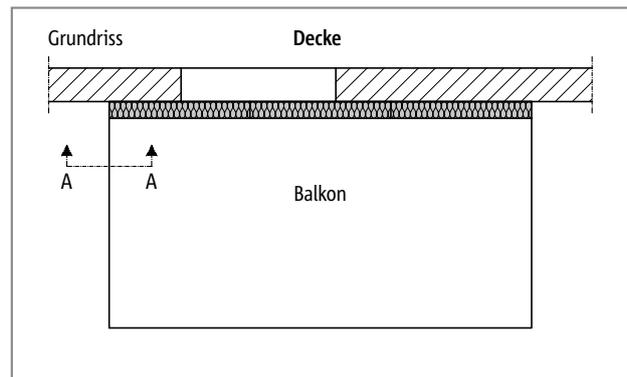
Schöck Isokorb® Typ KXT: Balkon frei auskragend
